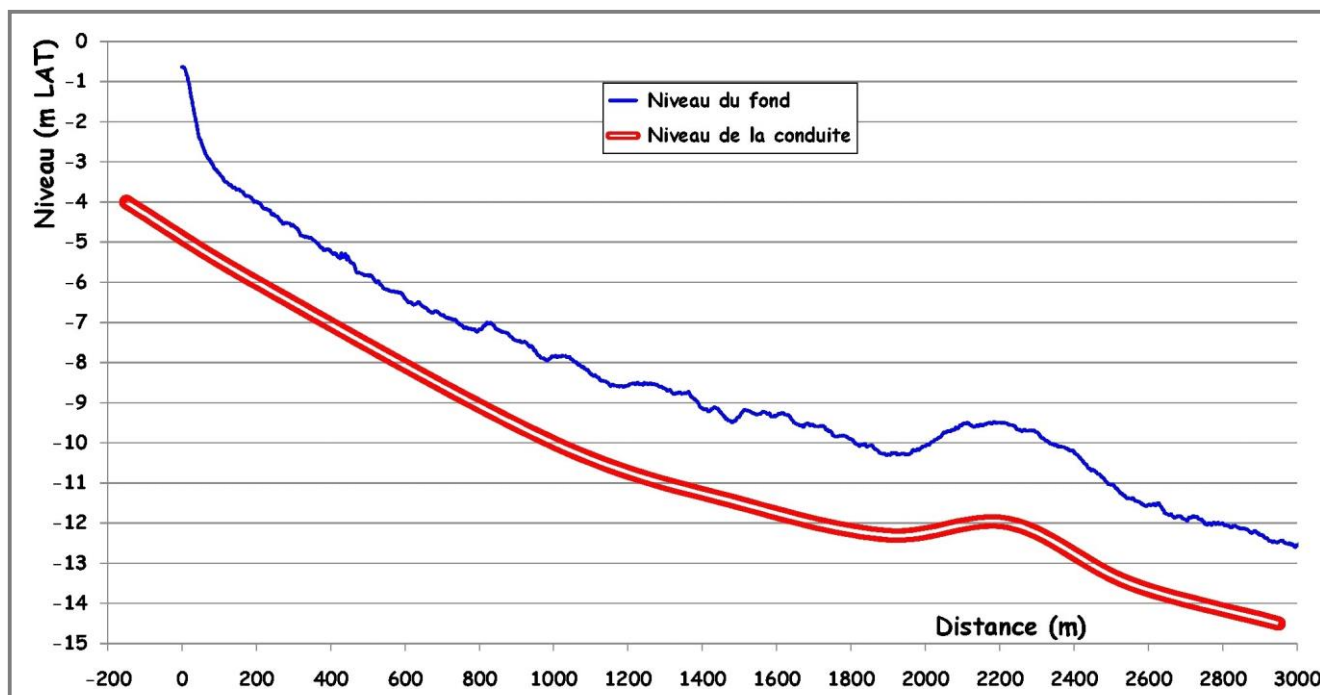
Tracé préconisé de la conduite dans le cas d'une profondeur d'ensouillage de 2 m au large
